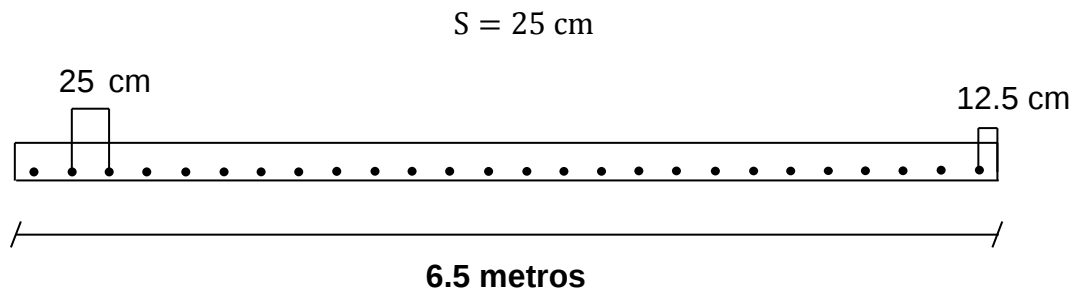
Detalle de armado de la losa de aproximación, Vista transversal.
